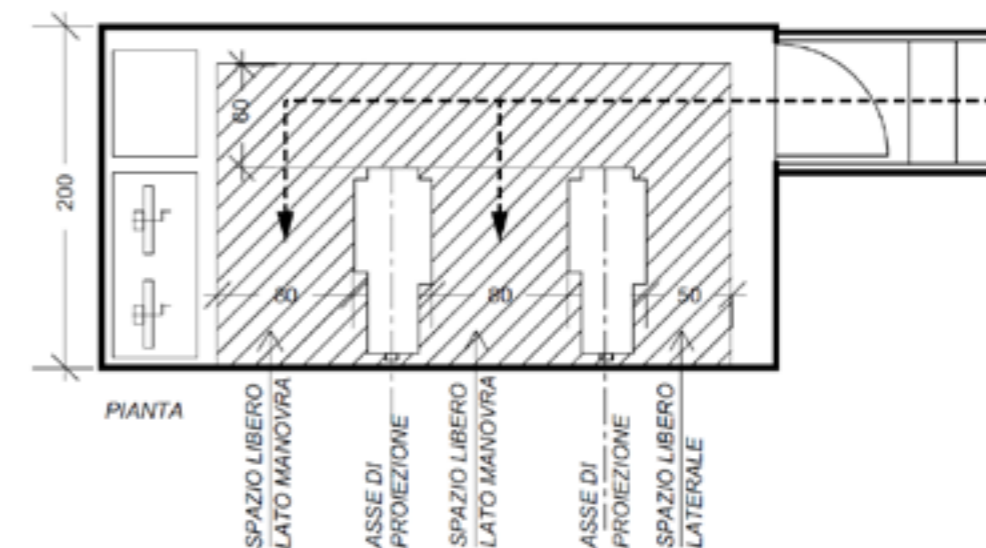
pianta di cabina di proiezione con due proiettori alternativi
